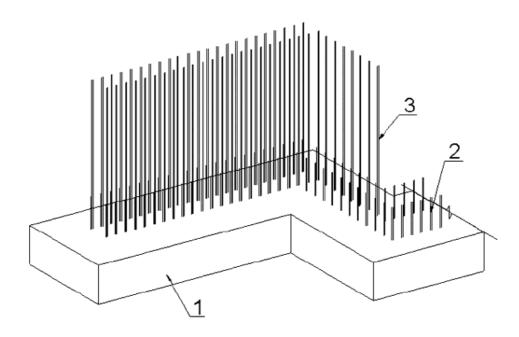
Армирование верхней части подпорной стены вертикальными отдельными стержнями
